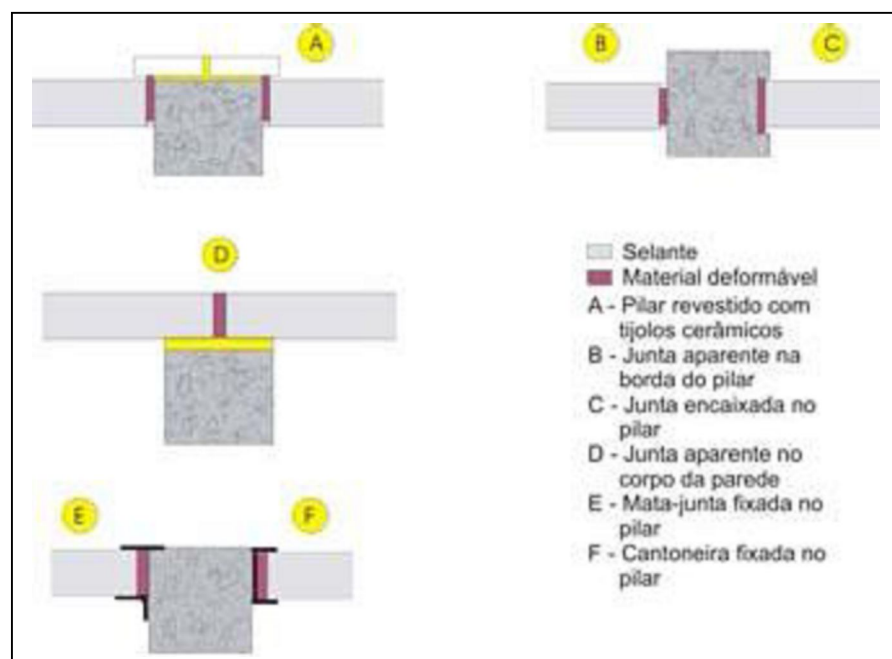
Ligações entre alvenaria e pilares, recomendadas para estruturas flexíveis. [38]
